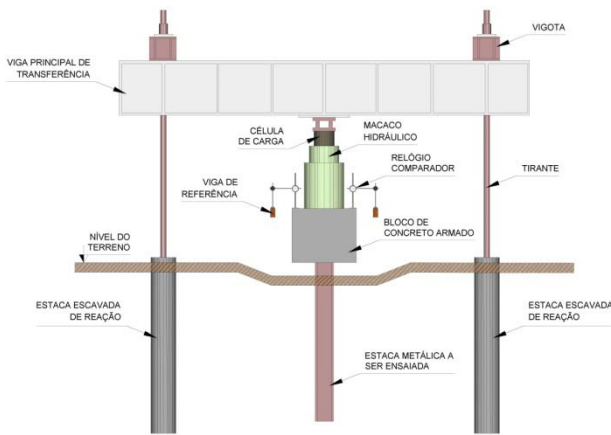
Croqui e detalhes do sistema de prova de carga utilizado nas estacas tipo trilho TR 37.
